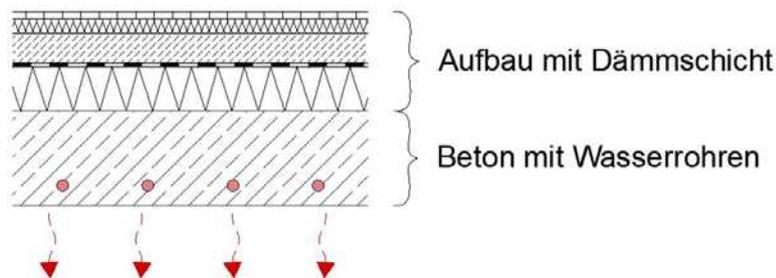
Skizze einer Geschosdecke mit Wasserrohren zur Betonkernaktivierung
